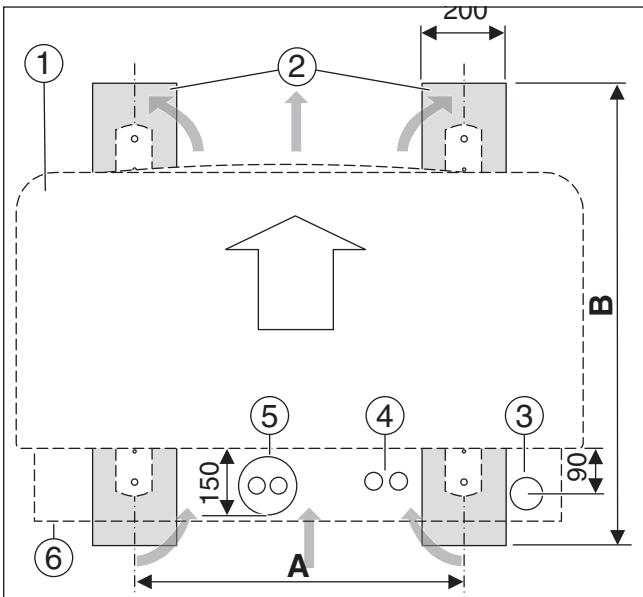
Lage der Fundamente und Rohre (SAO ...-2)
